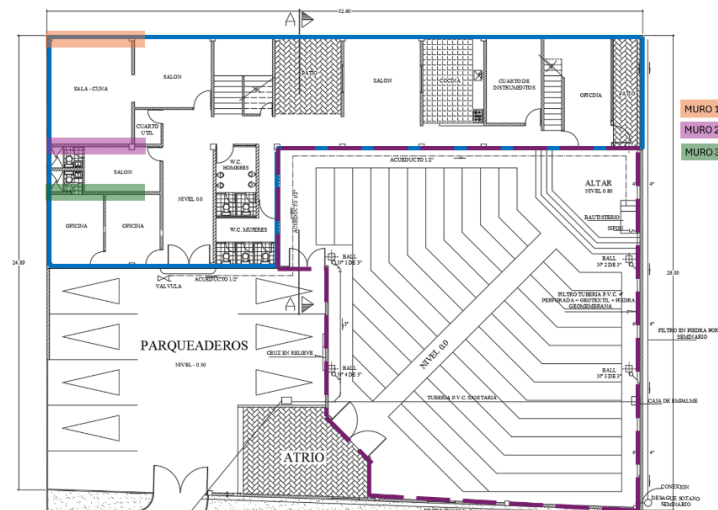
Plano arquitectónico (línea morada punteada hace parte de la estructura metálica y línea azul continua hace a pórticos en concreto reforzado de tres niveles).
